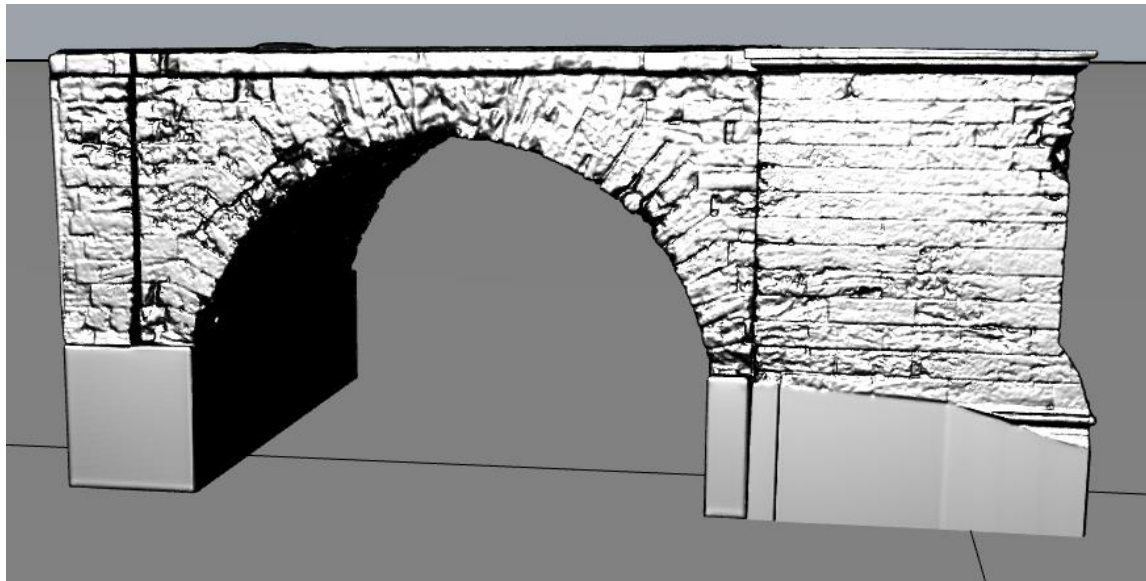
Malla del estribo del puente unido. Fuente: elaboración propia en Rhino
